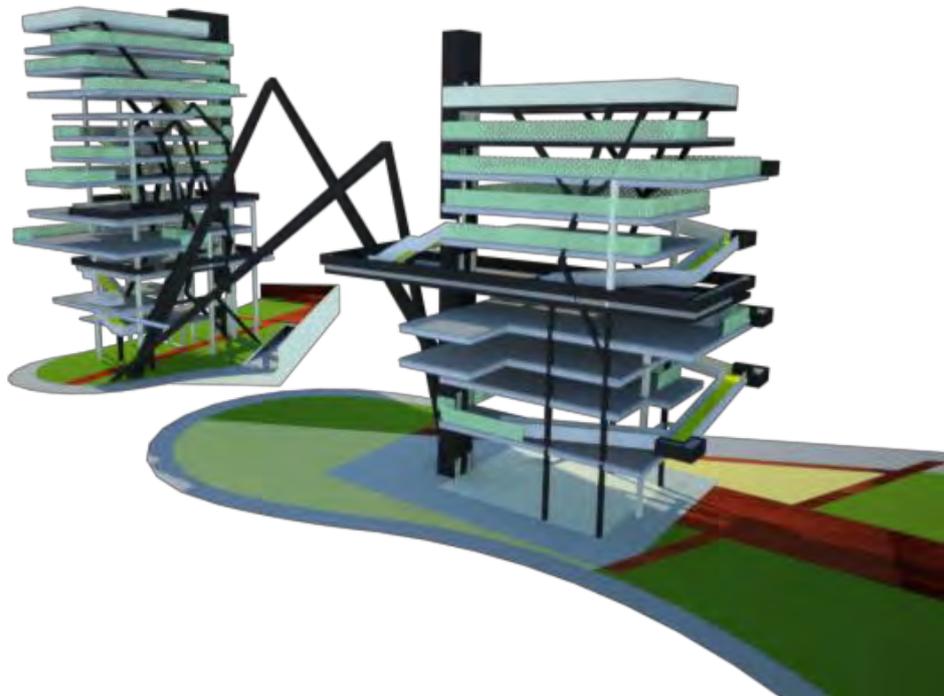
Rampas e escadas de acesso e, jardineiras espalhadas em alguns pavimentos e no piso de descanso das rampas.
